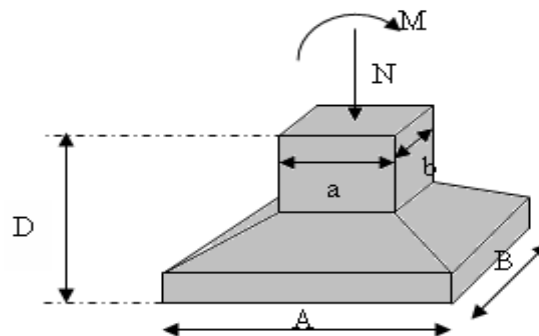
Représentation des semelles isolées sous poteaux carrés
